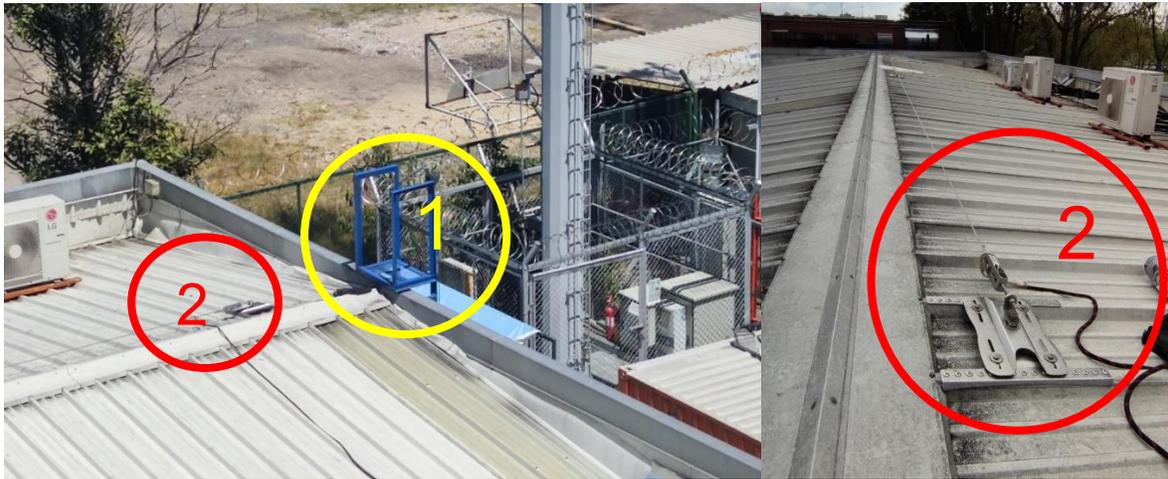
Sistema de anclaje para acceder a la cubierta del Hangar
